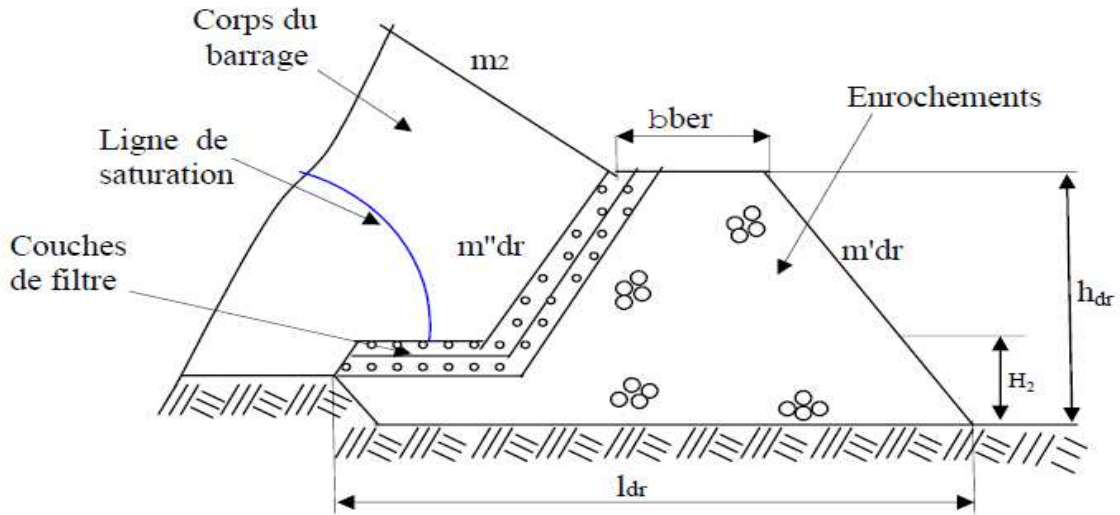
Prisme de drainage avec drain tapis interne sur fondations imperméables (Messaid, 2002).
